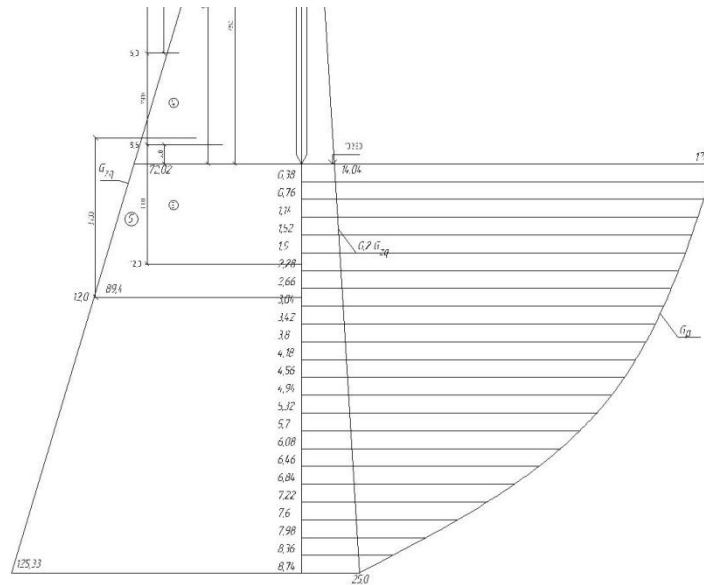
Схема к расчёту осадки свайного фундамента методом элементарного суммирования, по крайнему фундаменту
